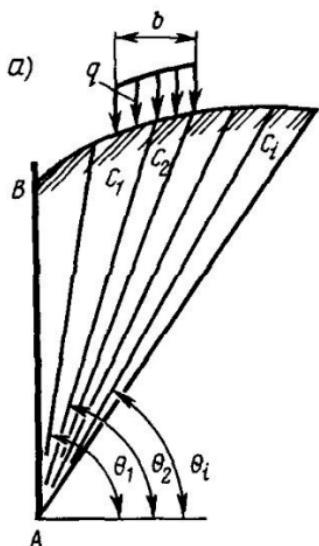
Схема для определения активного давления песка или супеси на стенку ограждений при произвольном очертании поверхности грунта и расположении на ней нагрузки
